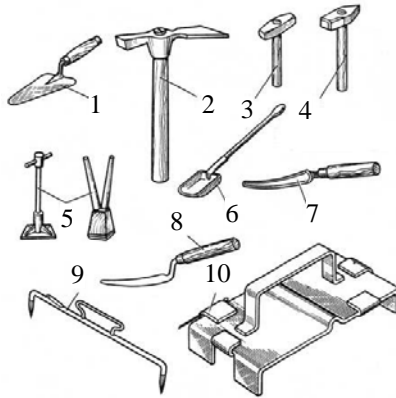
Інструменти для виробництва кам'яного мурування: 1 – кельма; 2 – молоток-тесельце; 3 – кувалда прямокутна; 4 – те саме, гостроноса; 5 – трамбівка; 6 – лопата розчинова; 7 – розшивка для оброблення опуклого шва; 8 – те саме, для оброблення увігнутого шва; 9 – причальна скоба з заціпкою; 10 – те саме, з оцинкованого листа зі шнуром.
